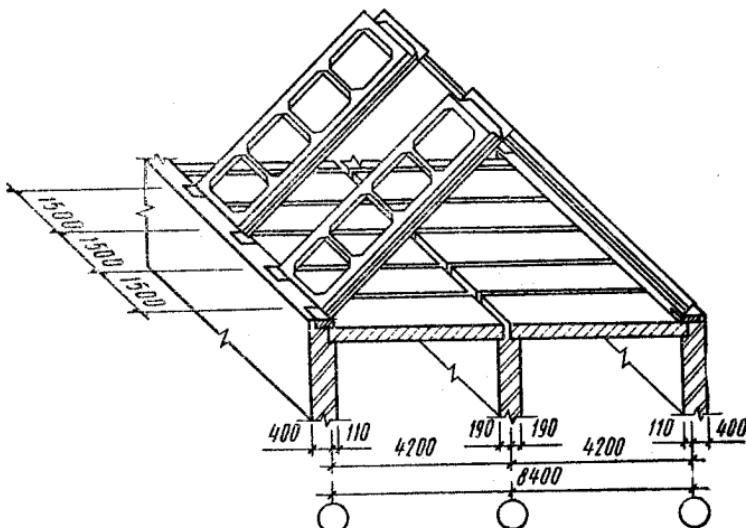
Стропильные конструкции из «скелетных» плит
